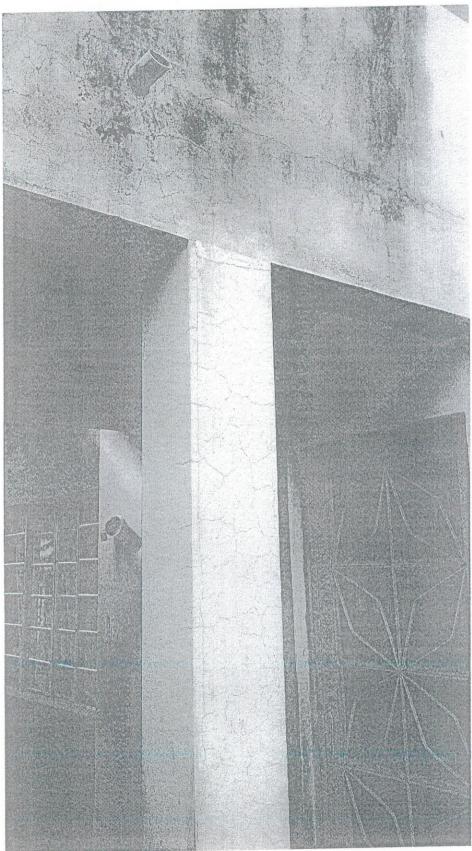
Fissuração em pilar da caixa de escada
